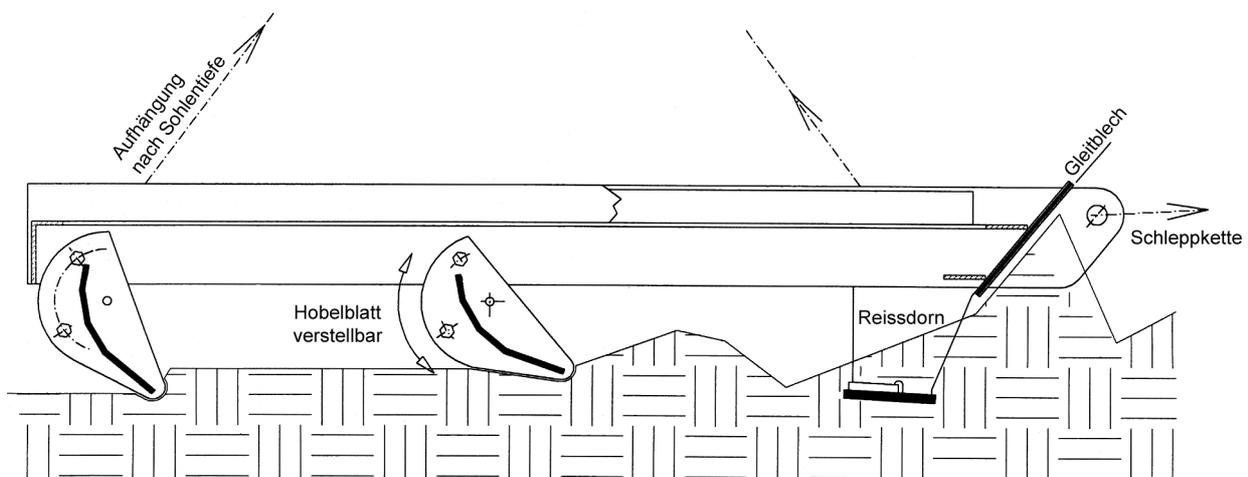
Prinzipskizze: Seitenansicht des Sandhobels
